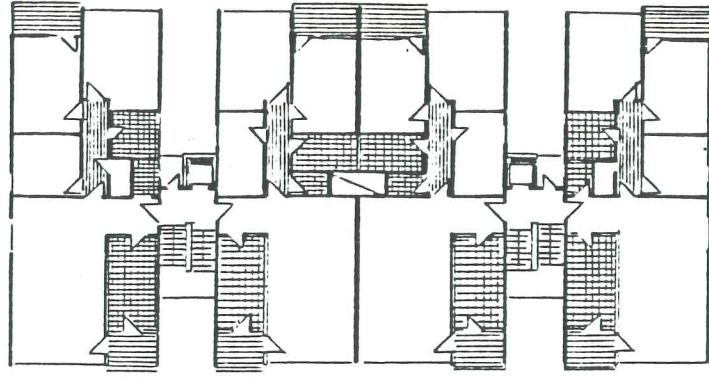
Ufuk, Yamaç, I, ve Yankı blokları vaziyet planı.
